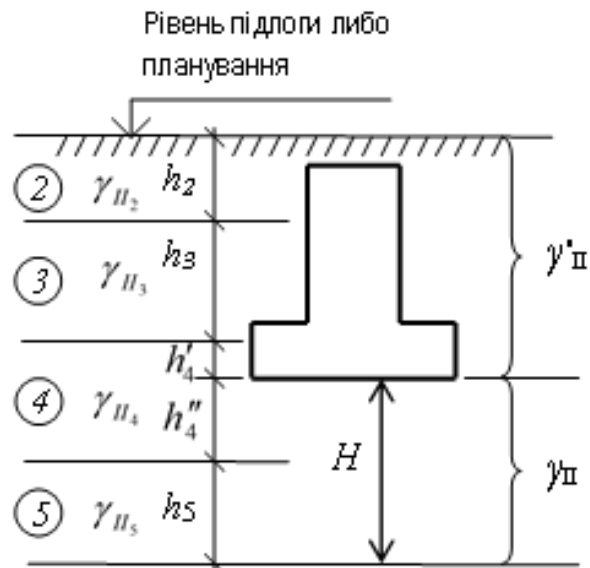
Схема до розрахунку питомої ваги ґрунту, розташованих вище і нижче від підшви фундаменту
